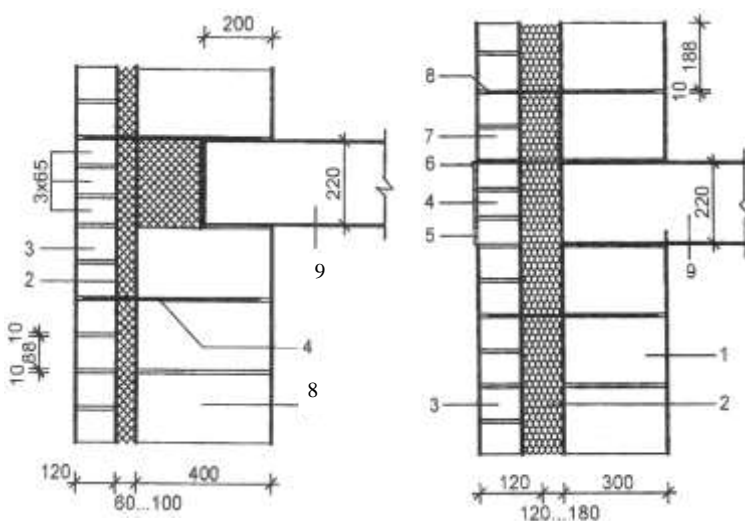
Вертикальні розрізи тришарових зовнішніх стін з блоків ніздрюватих бетонів і внутрішнім утеплювачем:
